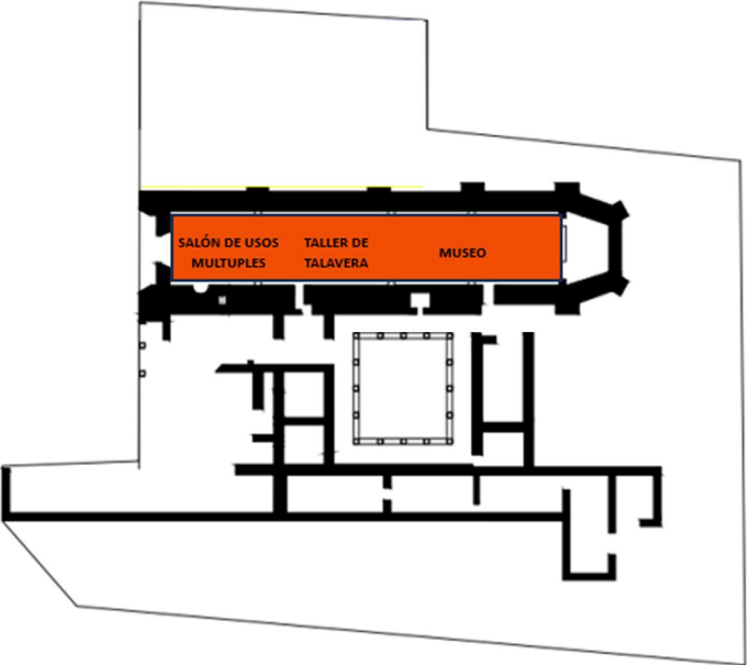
Planta de losa. 2023 imagen: Lucero Gómez
